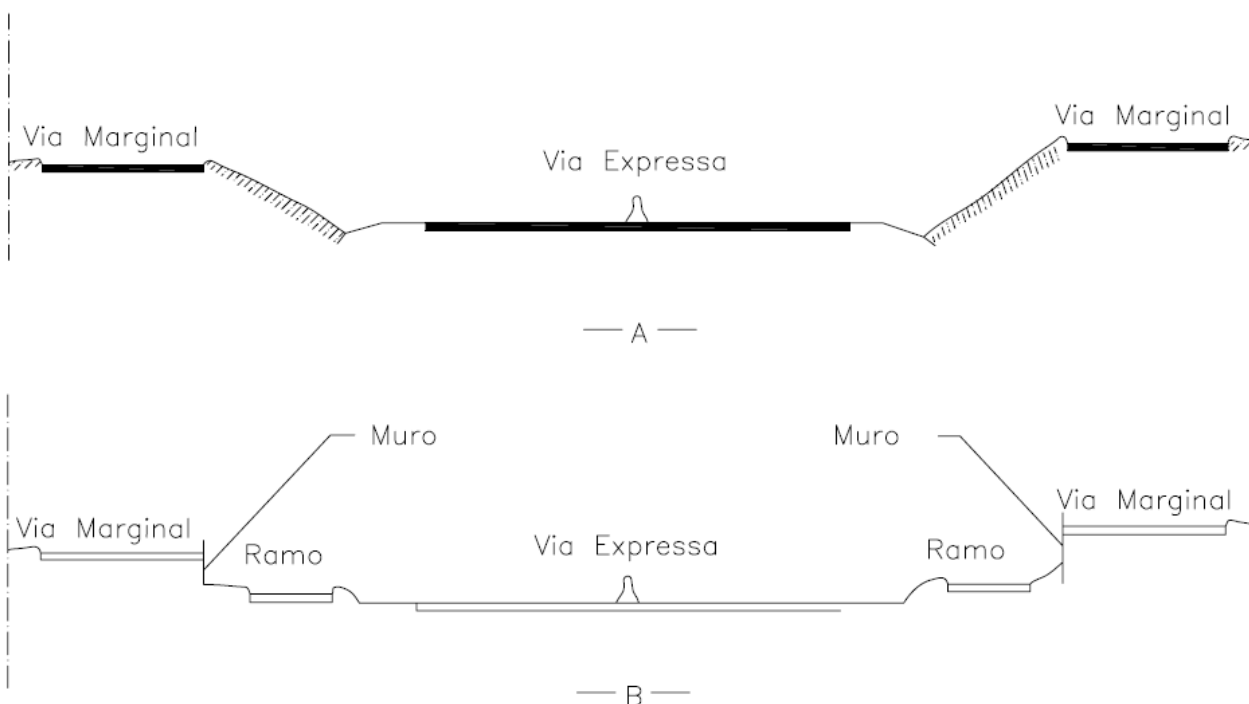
Seções Transversais de Vias Expressas Enterradas
